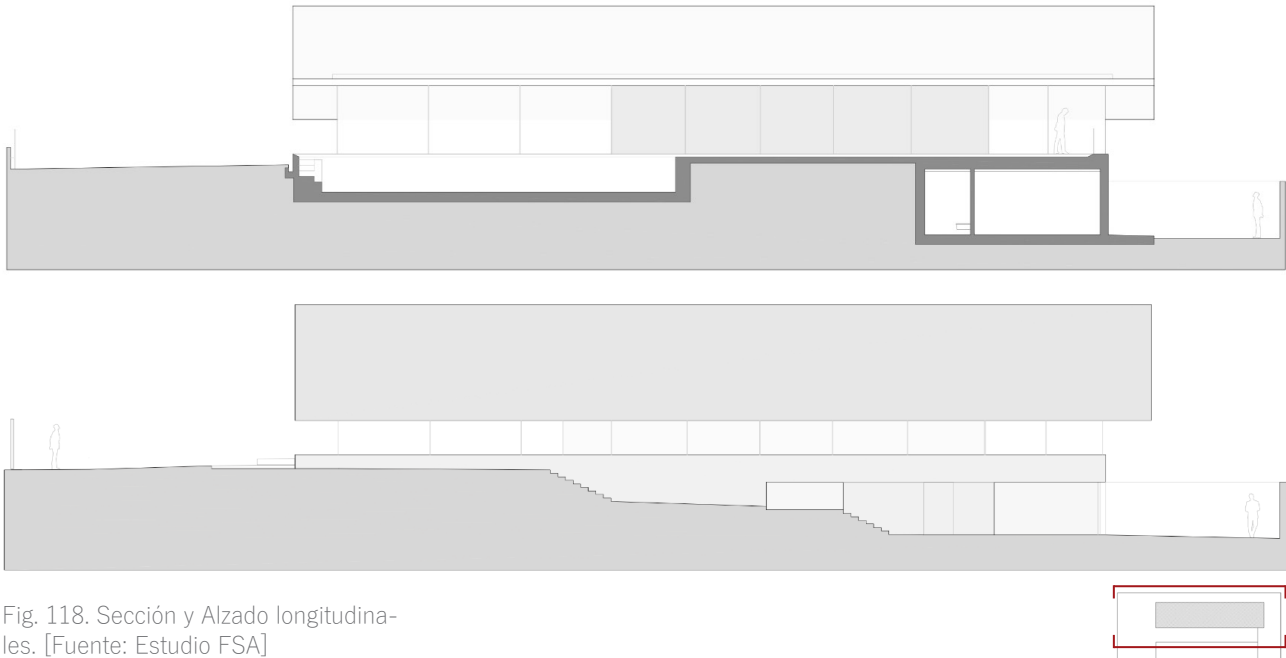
Sección y Alzado longitudinales. [Fuente: Estudio FSA]
